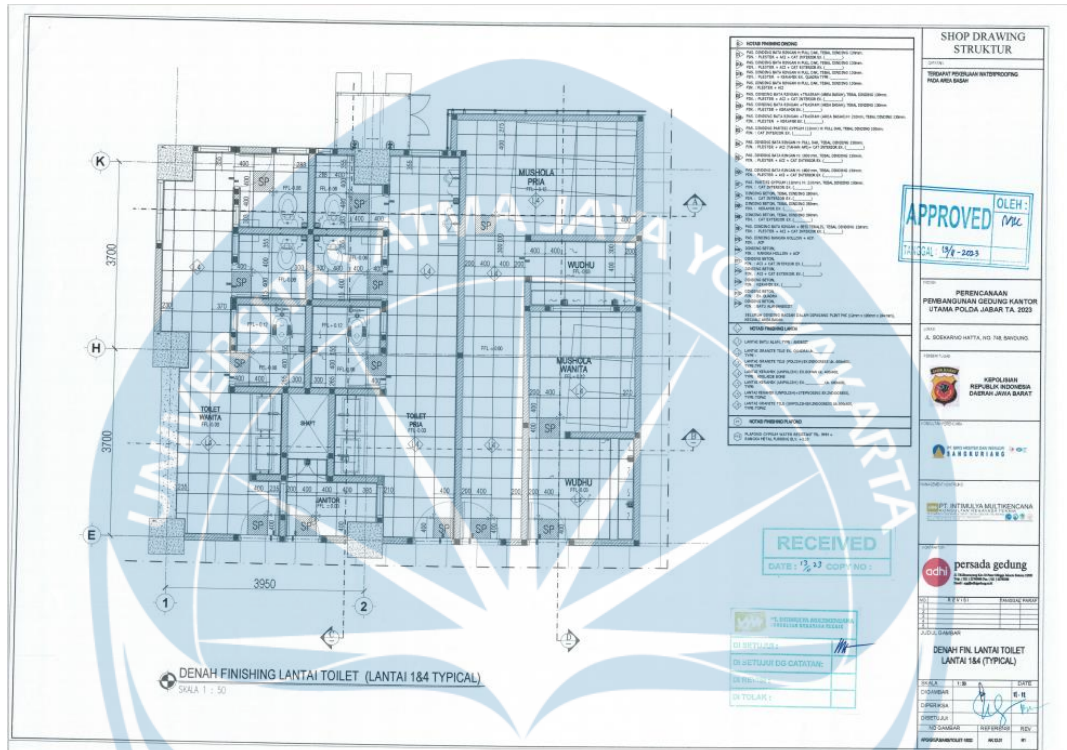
4 Gambar Denah Toilet Lantai 1 dan 4 Tipikal
